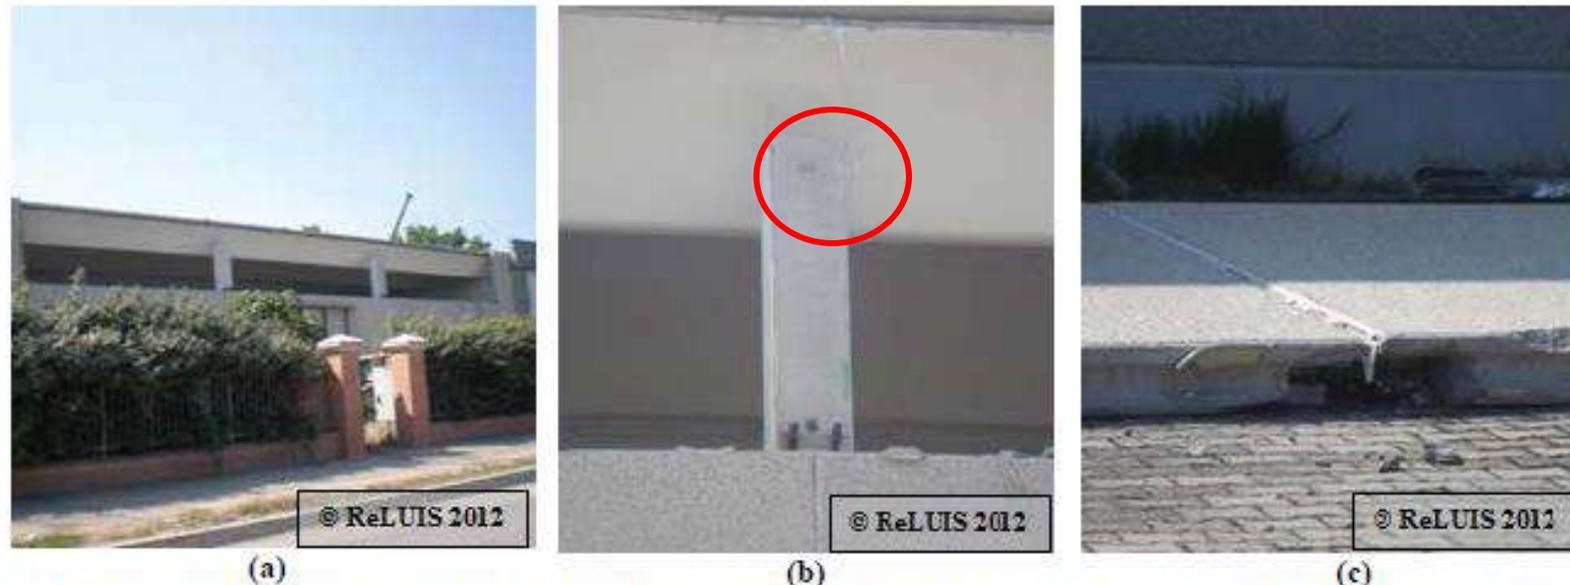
(a) Crollo dei pannelli orizzontali di tamponamento; (b) dettagli connessione in corrispondenza del pilastro e (c) e dettaglio ancoraggio sul pannello
